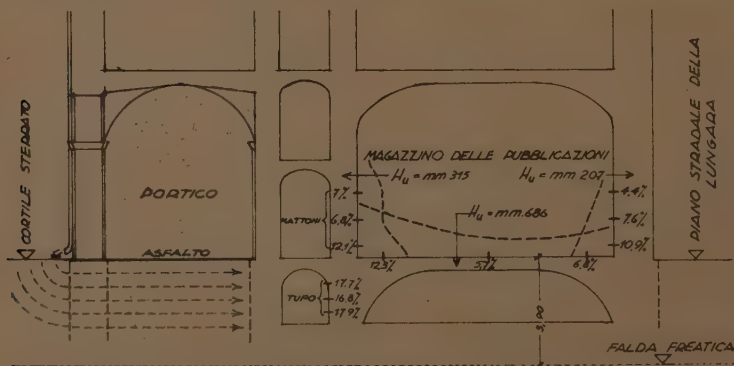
Distribuzione dell'umidità in una sezione caratteristica di Palazzo Corsini: massimo carico (mm. 686) nel pavimento.
